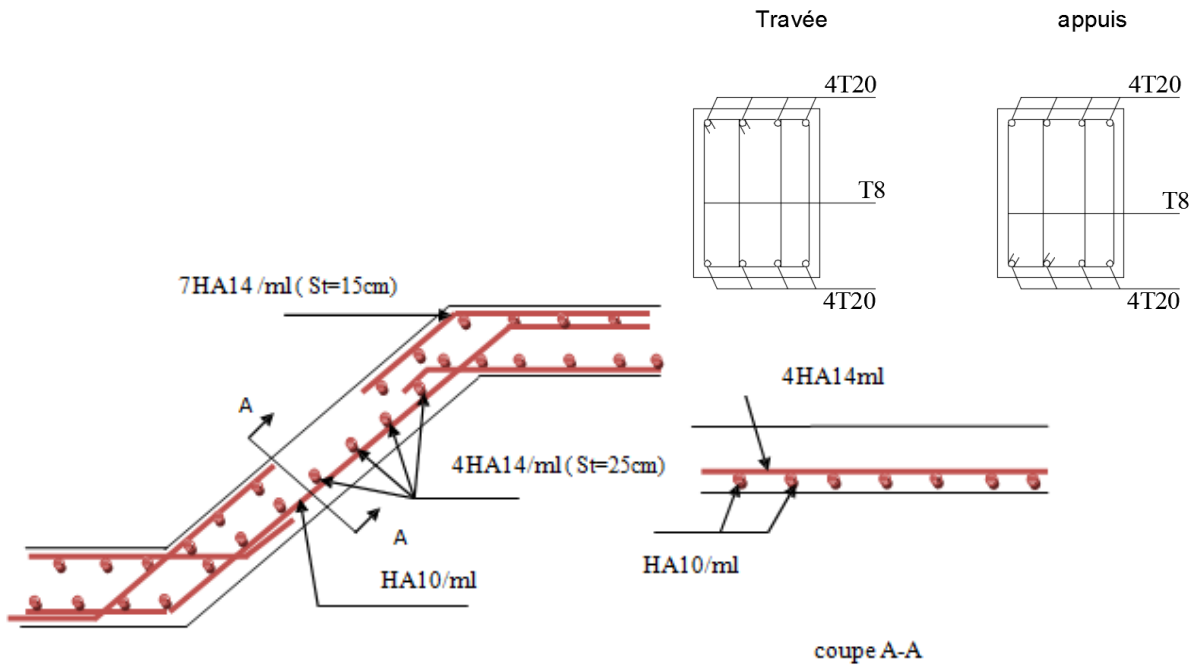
Disposition constructive des armatures des Escaliers quartier tournant.
